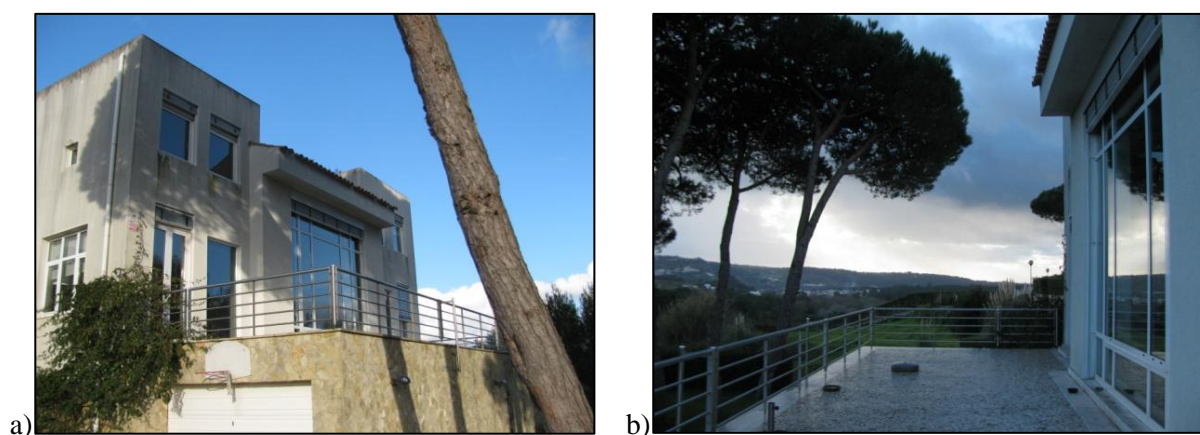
Vista interior do vão envidraçado de maior dimensão
